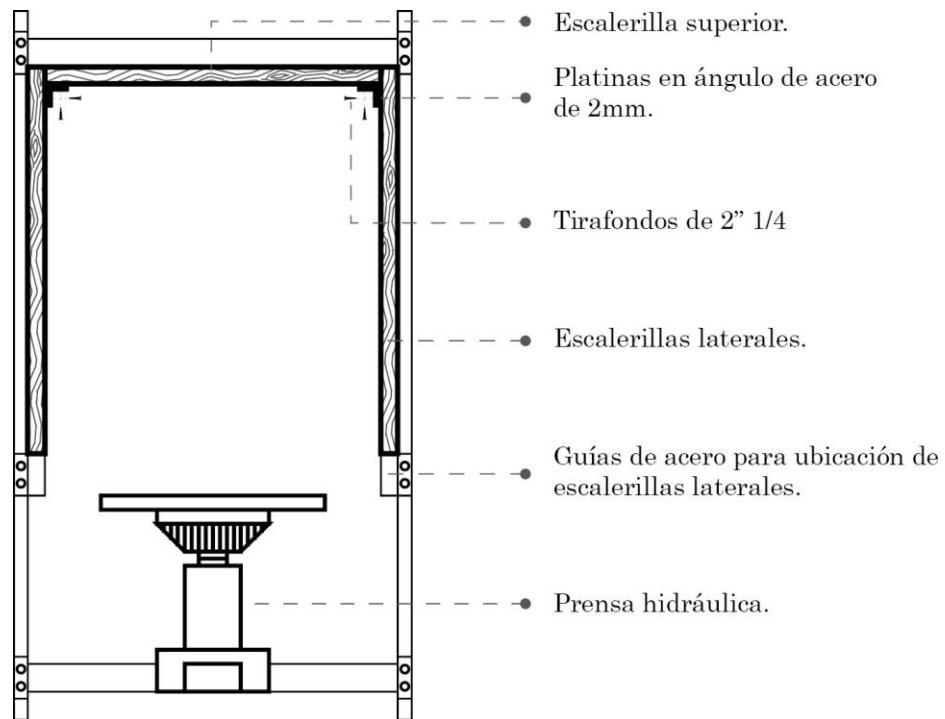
Ensamblaje de escaleras laterales a escalera superior.
